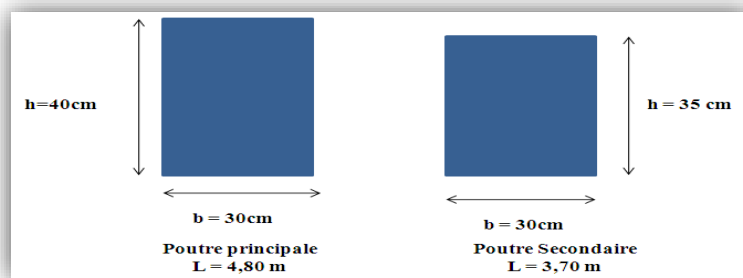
Dimensions des poutres principales et poutres secondaires.
